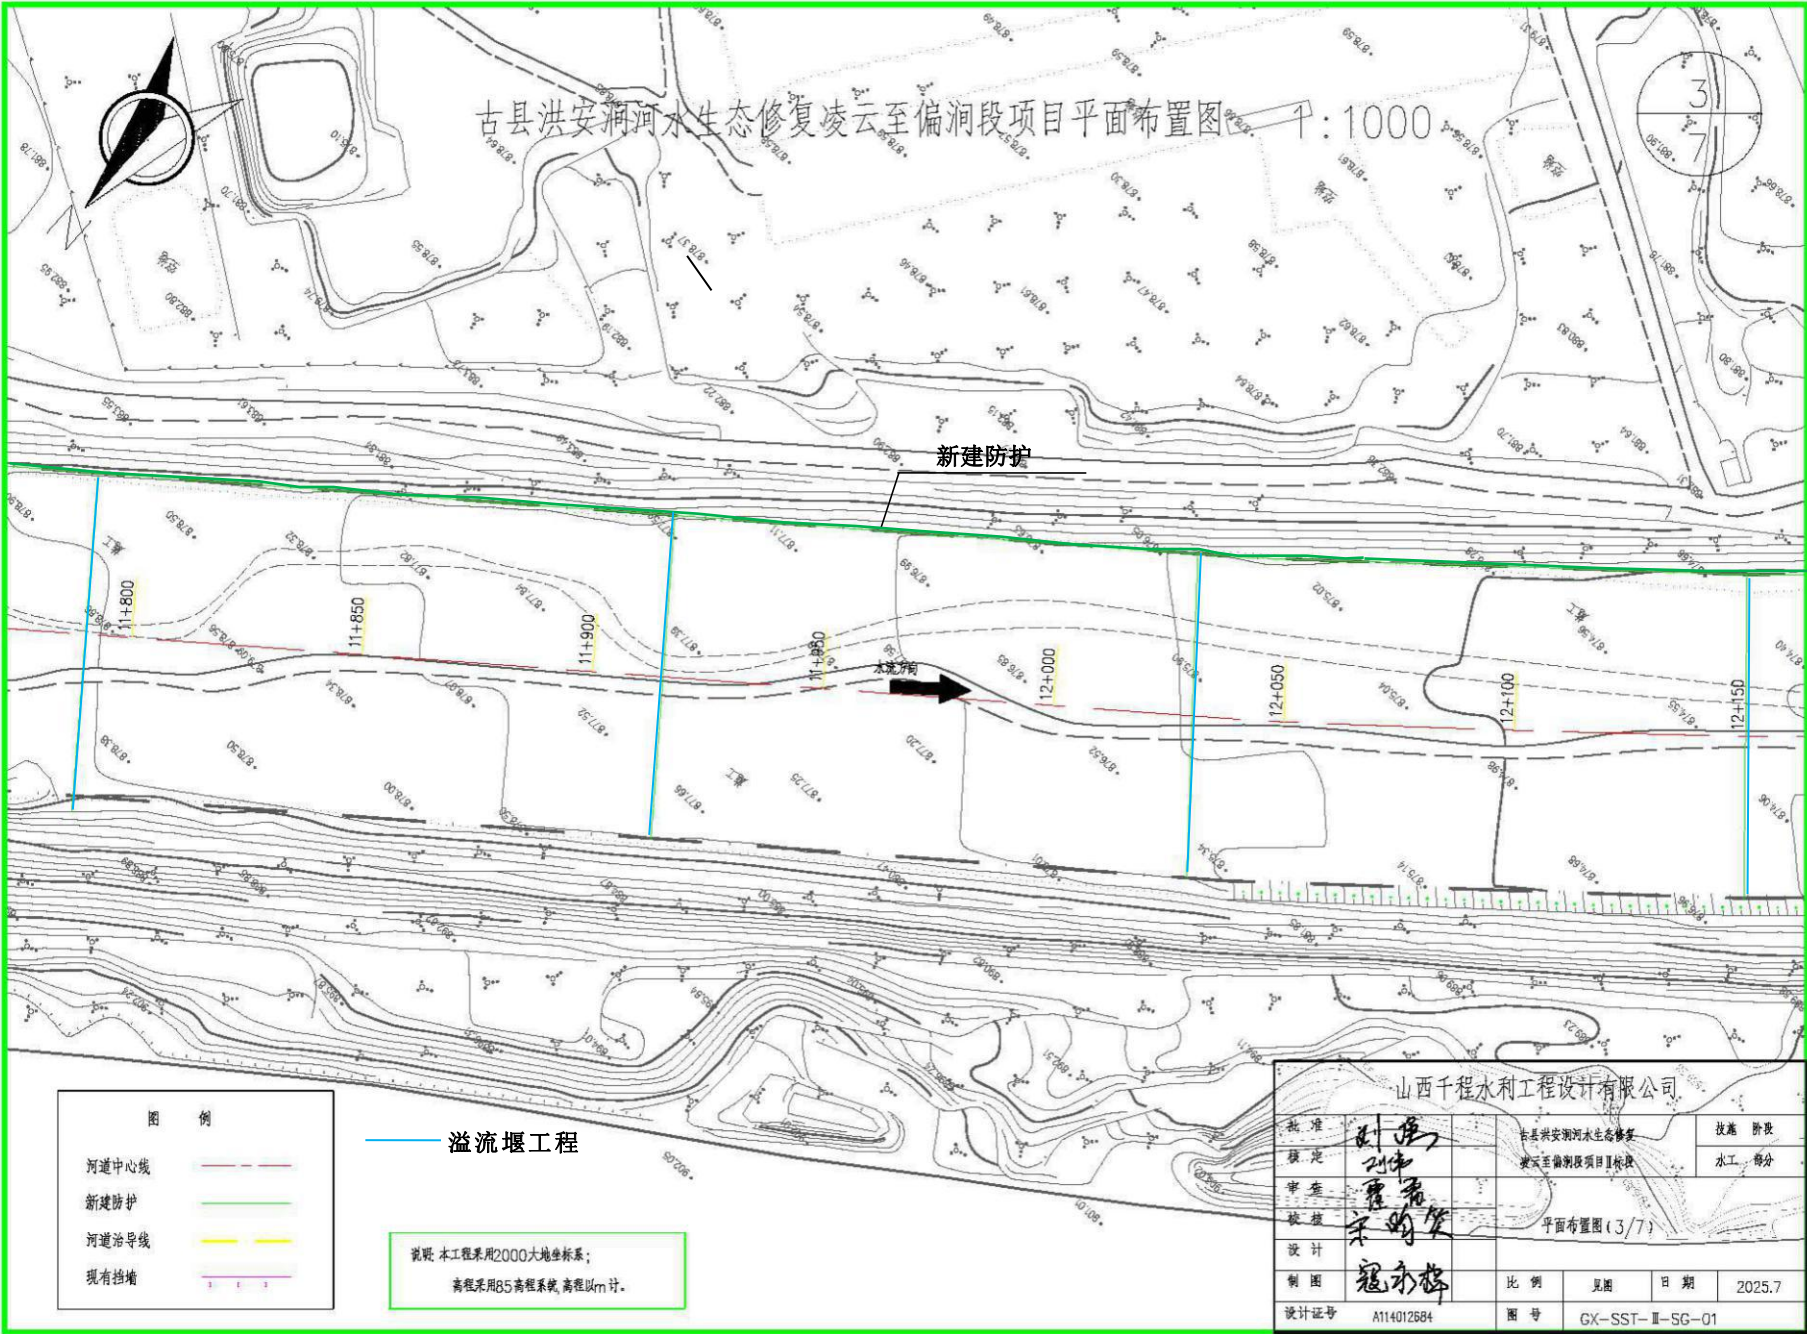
(7) 工程总平面布置图 (桩号 11+750-12+150)
